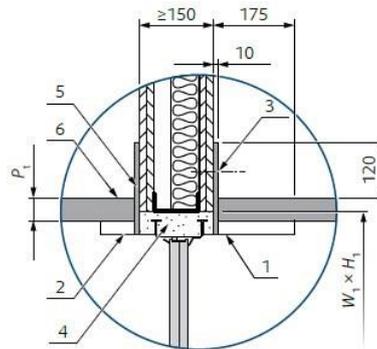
(E120S) Sezione trasversale di ① installazione umida in parete flessibile
